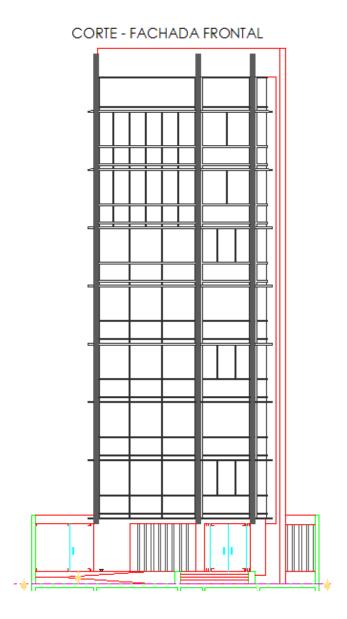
Fachada Frontal del Proyecto Centrum Curie
